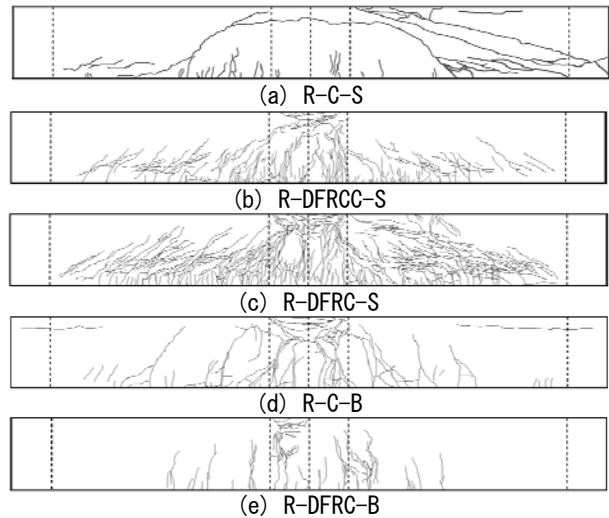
RC梁荷重試験により得られたひび割れ発生状況
